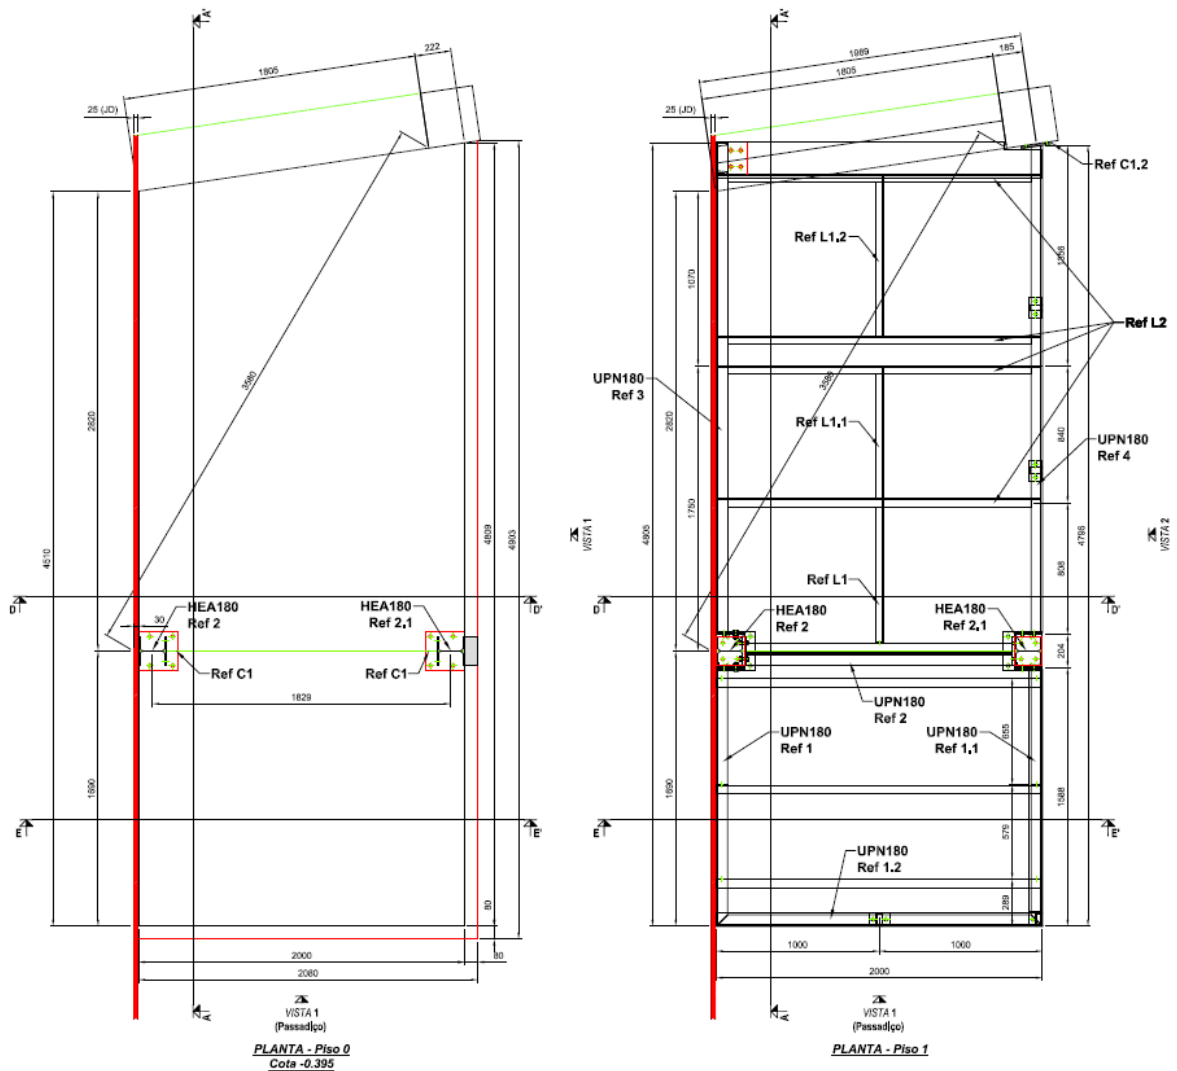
Projecto de execução das rampas metálicas – planta piso 0 e 1 [Montalfer, 2019]
